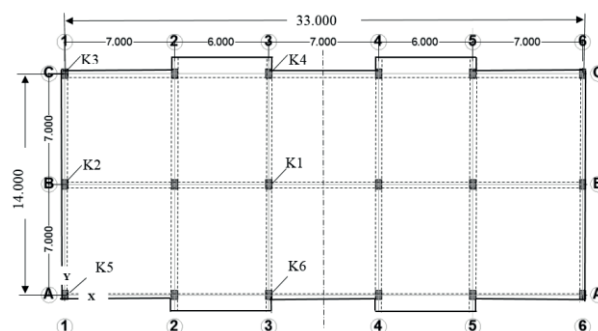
План типового этажа, исследуемого монолитного каркасного здания с кирпичными стенами заполнения
